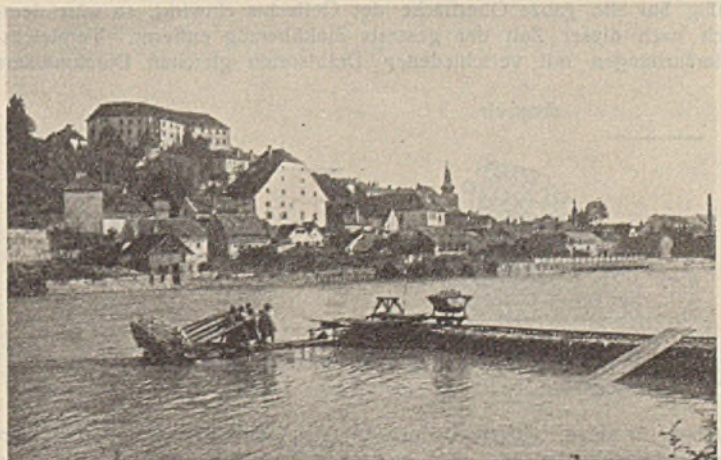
Bühnenbau aus viereckigen Drahtnetzbehältern in der Drau bei Pettau 1927. Versenken eines Drahtnetzbehälters zur Sicherung des Bühnenkopfes.
